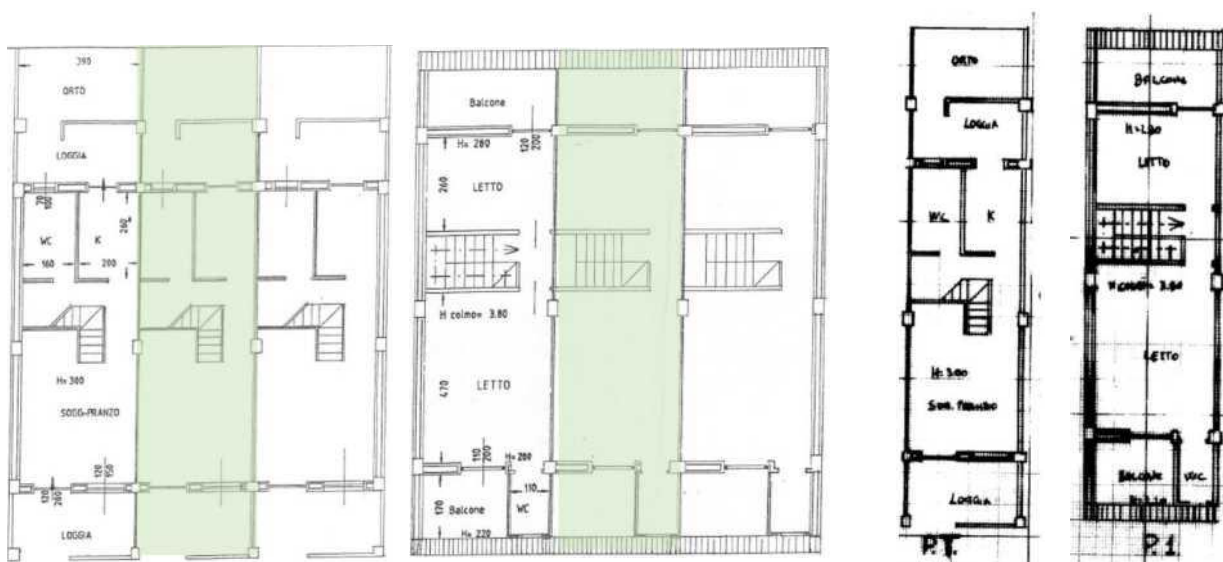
Appartamento sub 2 - Confronto tra la planimetria "assentita" e stato di fatto.
